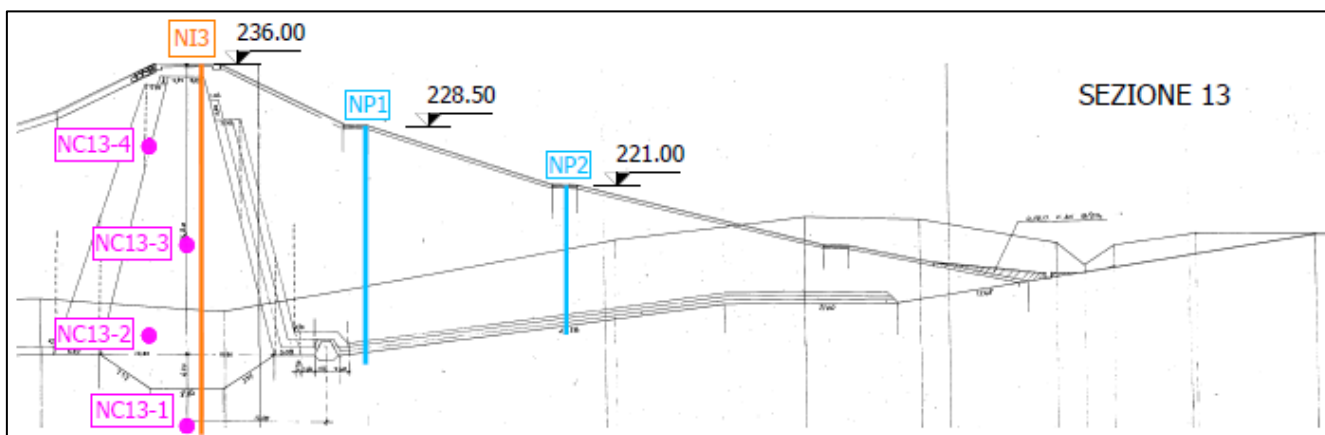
Posizione della nuova strumentazione nel corpo diga – Sezione 13
